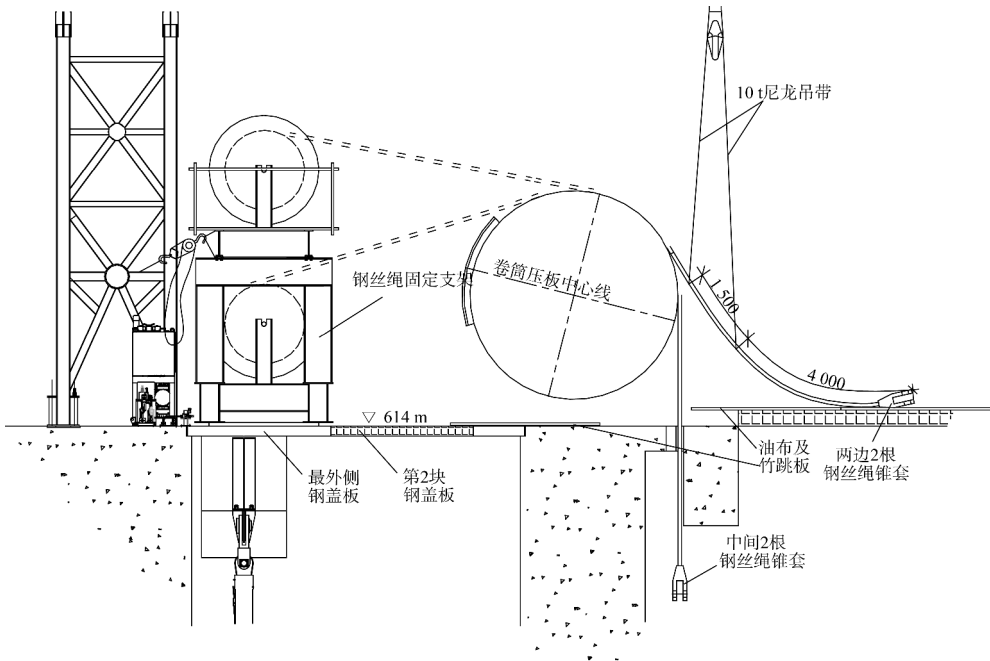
钢丝绳安装工装与卷筒相对位置 (单位: mm)
